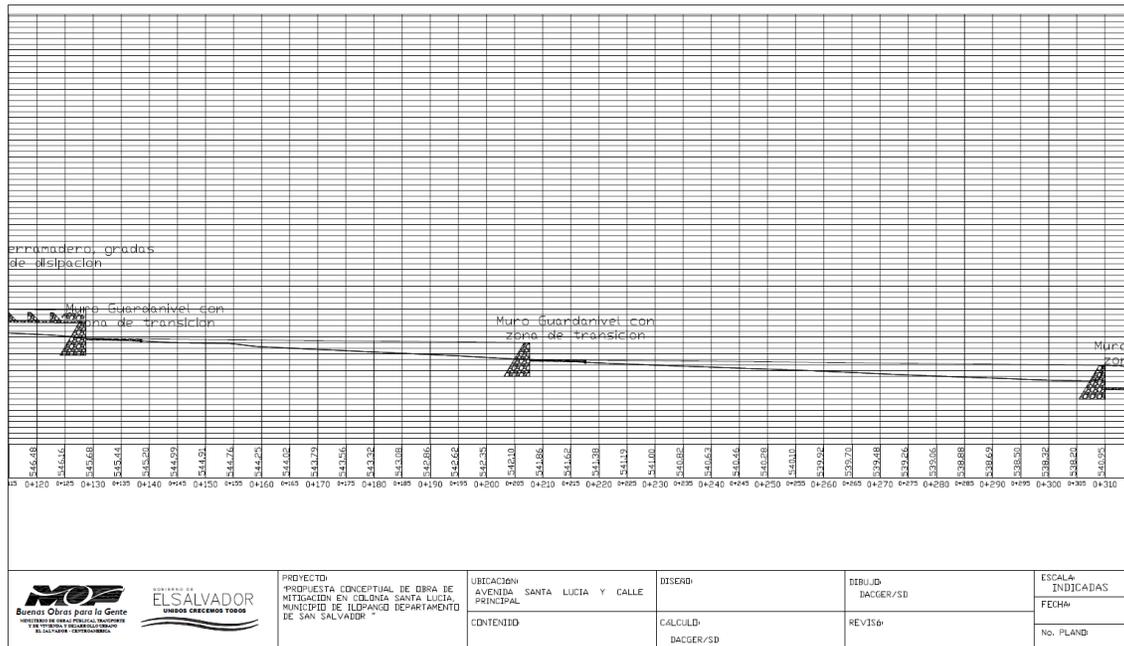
Esquema de obra propuesta de muros guardanivel en perfil.
